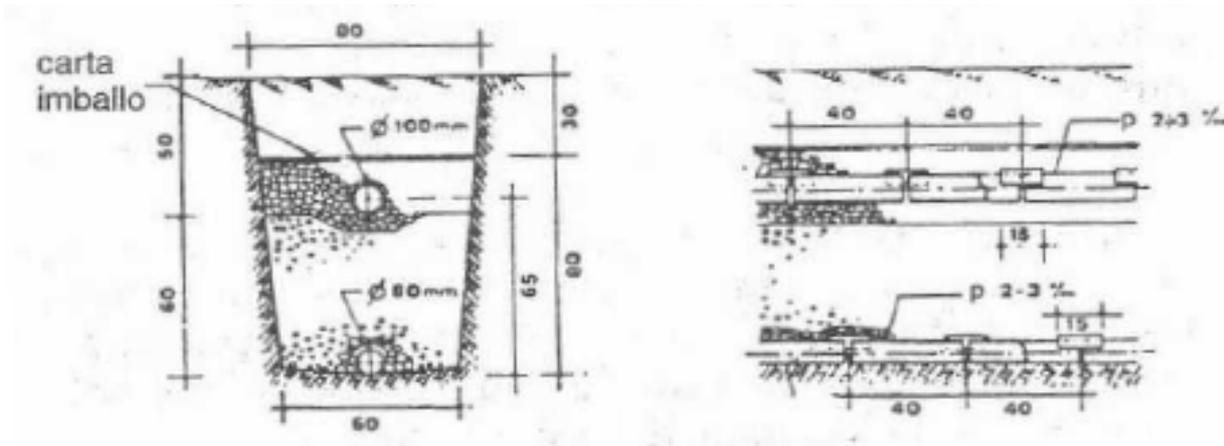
pianta e sezione longitudinale esemplificative di subirrigazione drenata (dal "Manuale dell'Architetto")
